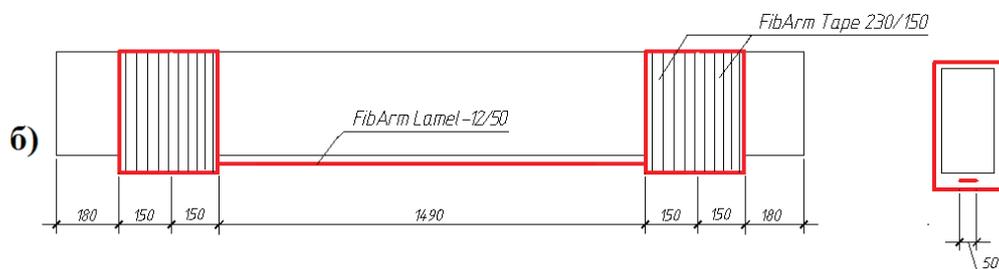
Схема оклейки железобетонных моделей углеродными ламелями
